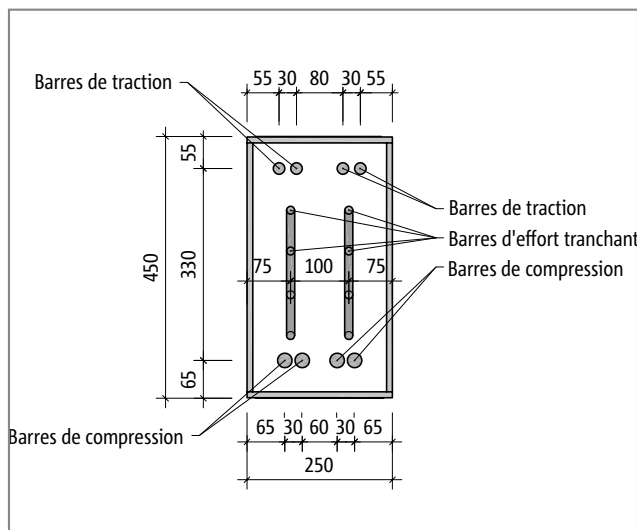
Schöck Isokorb® T Type B-M3-V2 en hauteur H450 : Vue du produit
